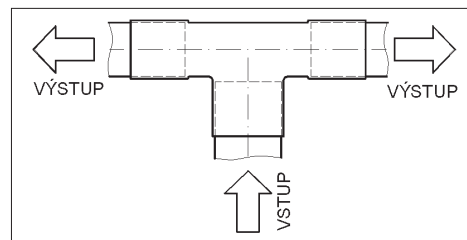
Spoj odbočky s hlavním potrubím fixovaný pomocným pájecím švem
